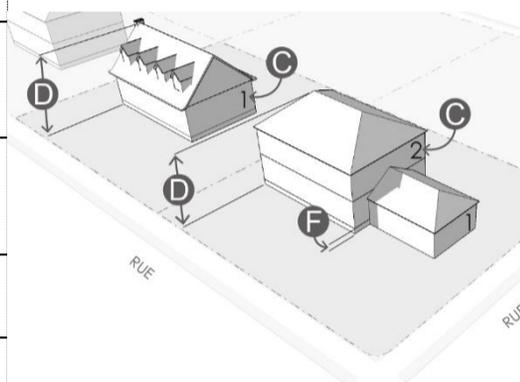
Hauteur d'un bâtiment et du plancher du rez-de-chaussée
